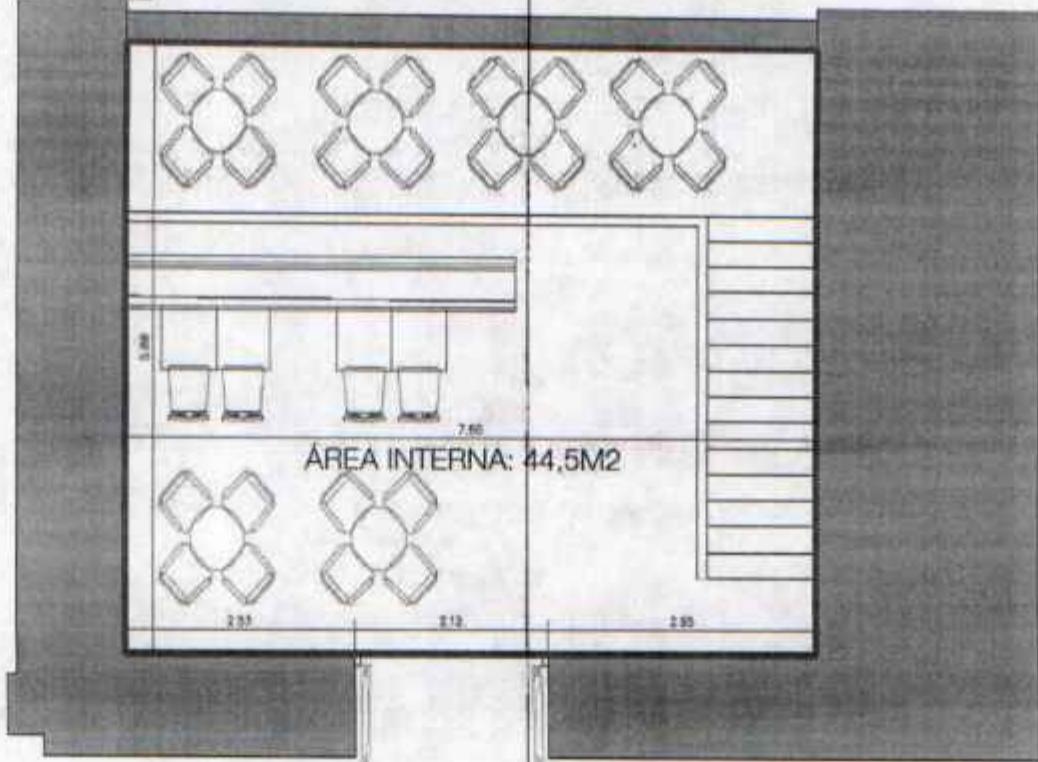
Plano SANTA MARIA DEL MAR GASTRO BAR - Área privada.
